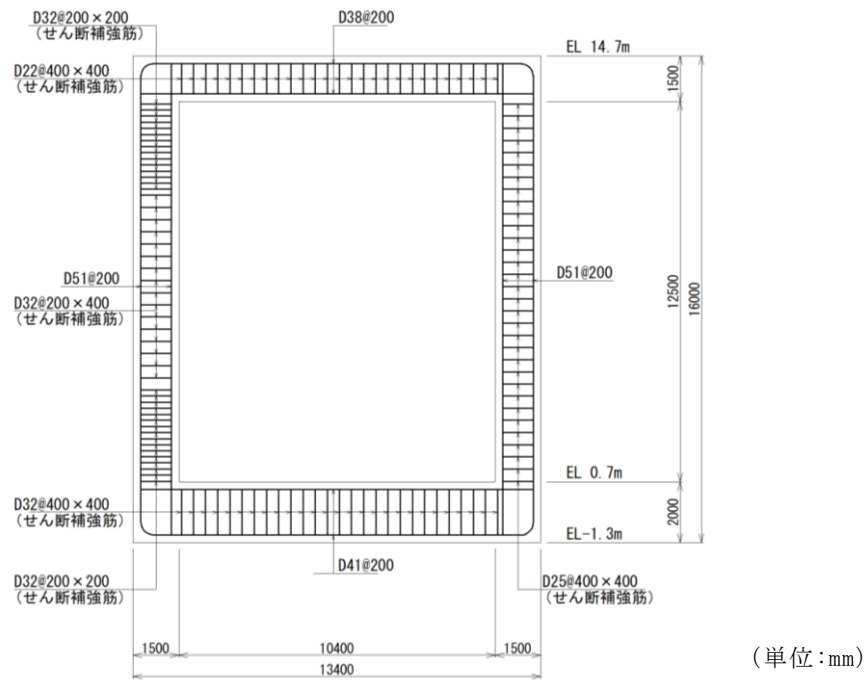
低圧原子炉代替注水ポンプ格納槽 概略配筋図 (B-B 断面)
